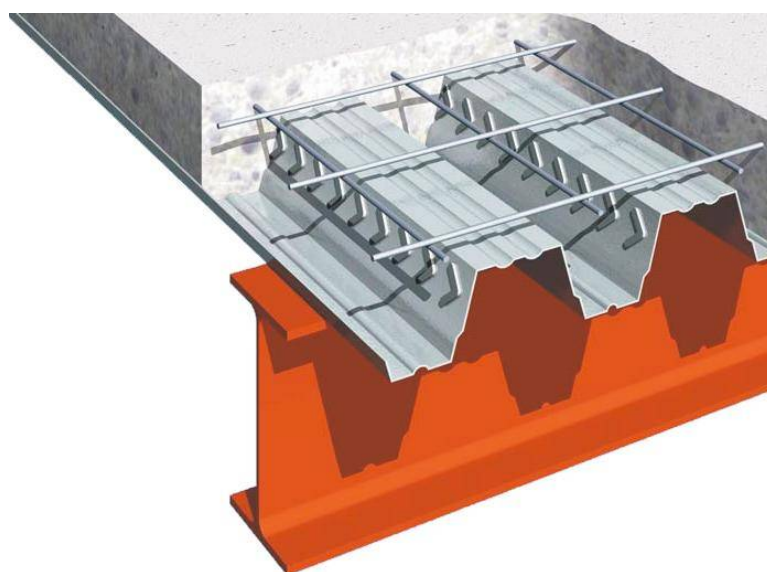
Vista tridimensional de uma laje mista (@futureng)
